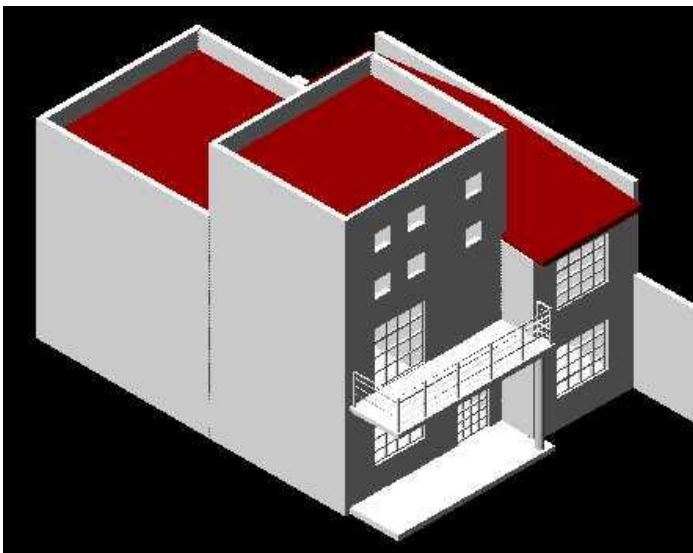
y 4. Vistas del modelo 3d de proyecto. Autoría propia
